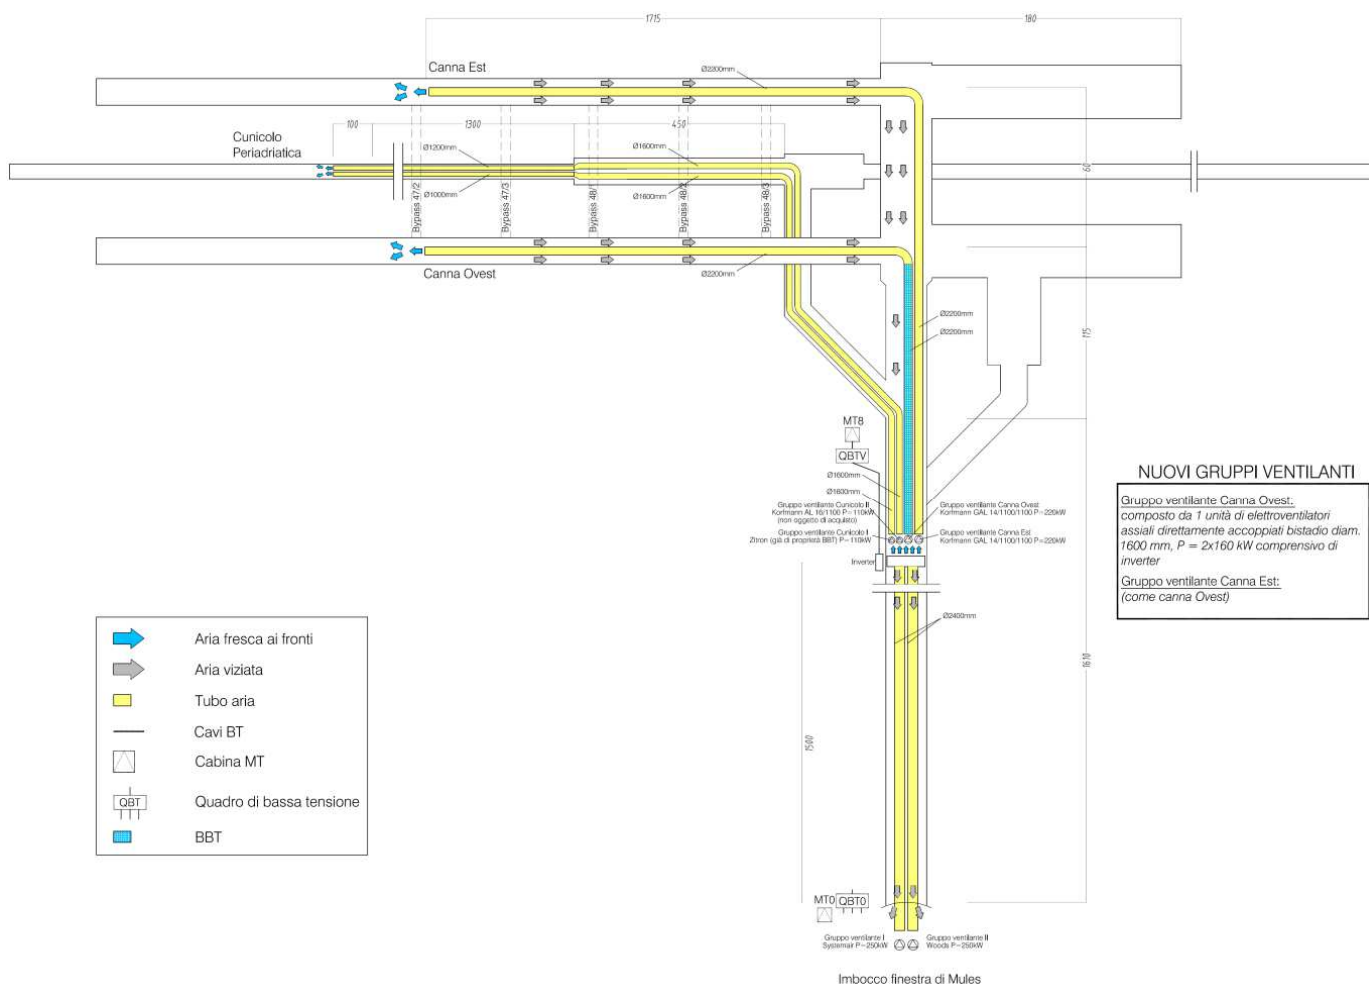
Ventilazione di cantiere esistente (Fonte:BBT)
